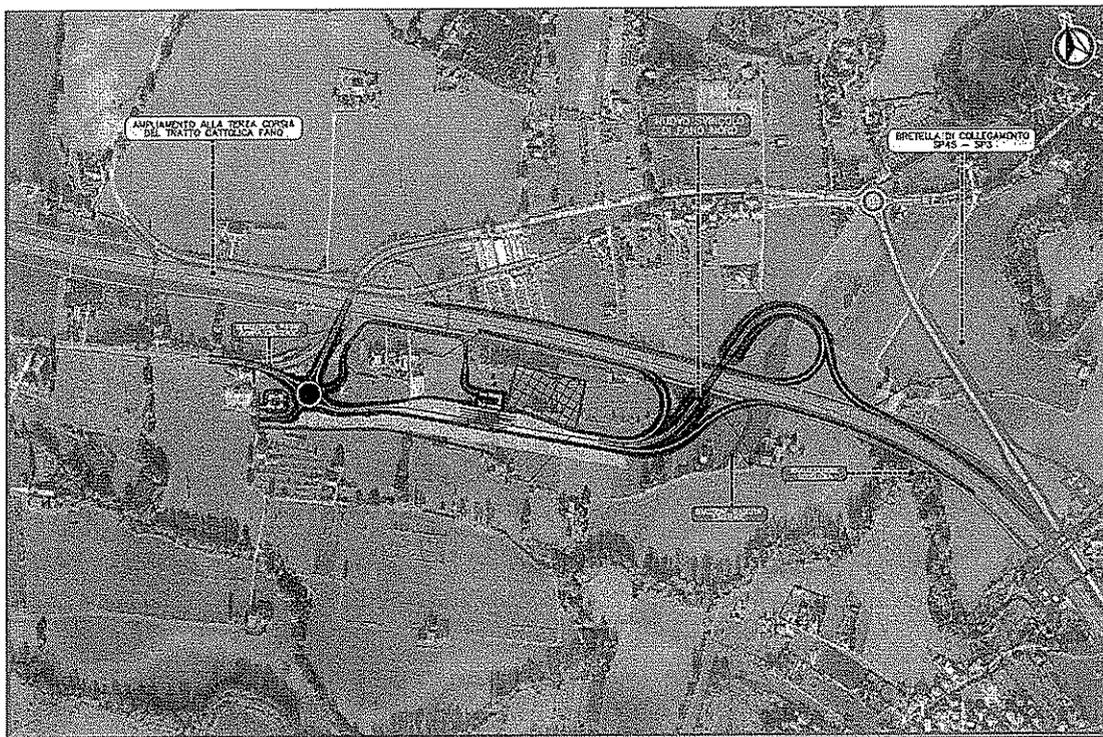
PLANIMETRIA DI PROGETTO SU ORTOFOTOCARTA
